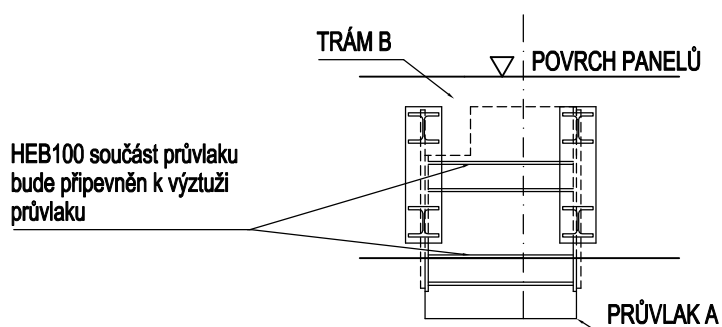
PŘIPOJENÍ TRÁMU NA PRŮVLAK
